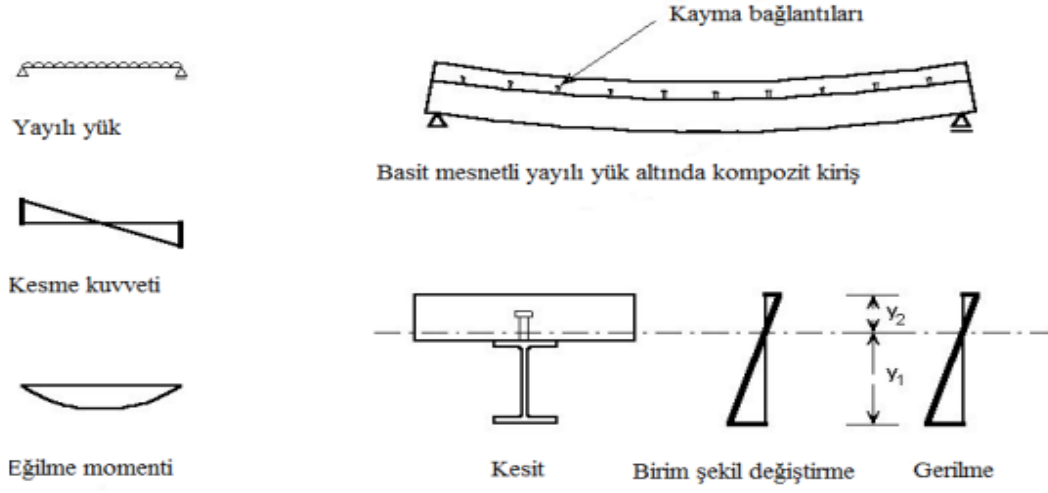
Kompozit ve betonarme kirişin düzgün yayılı yük altında davranışı
